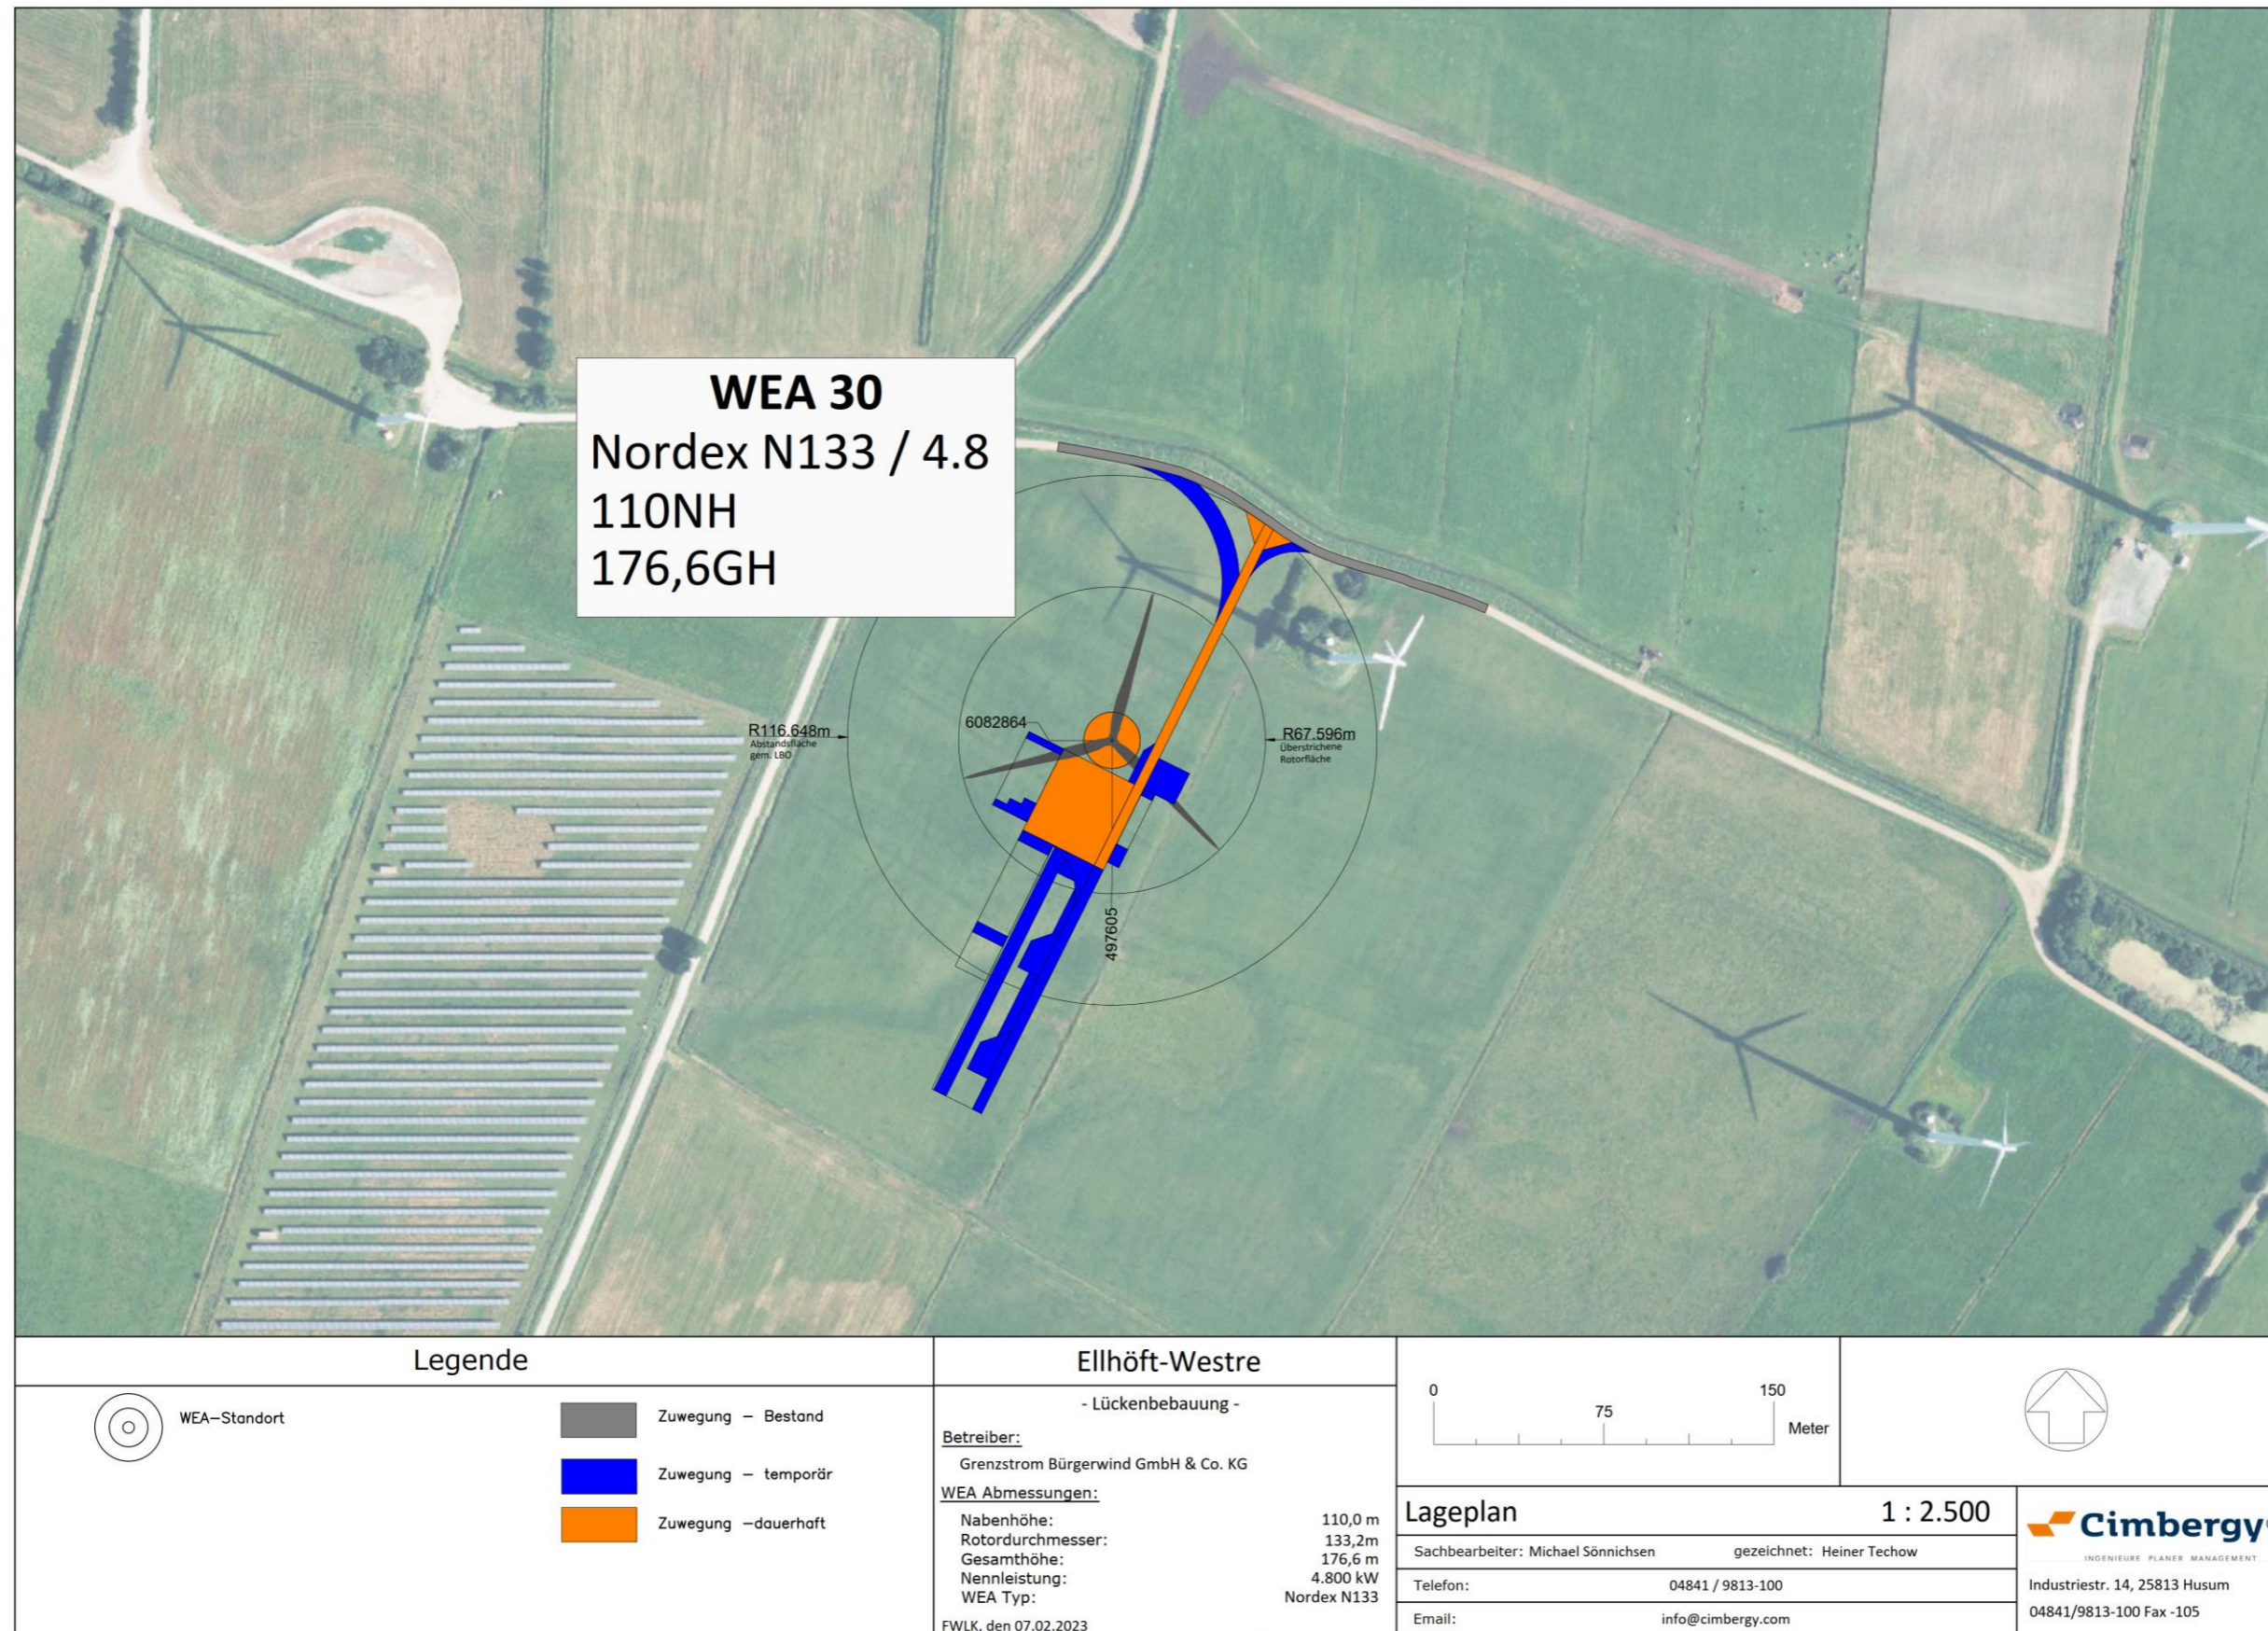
Planlægning af placering og adgang VEA 30 (Kilde: Cimbergy; sidst ændret: 08-02-2023)
